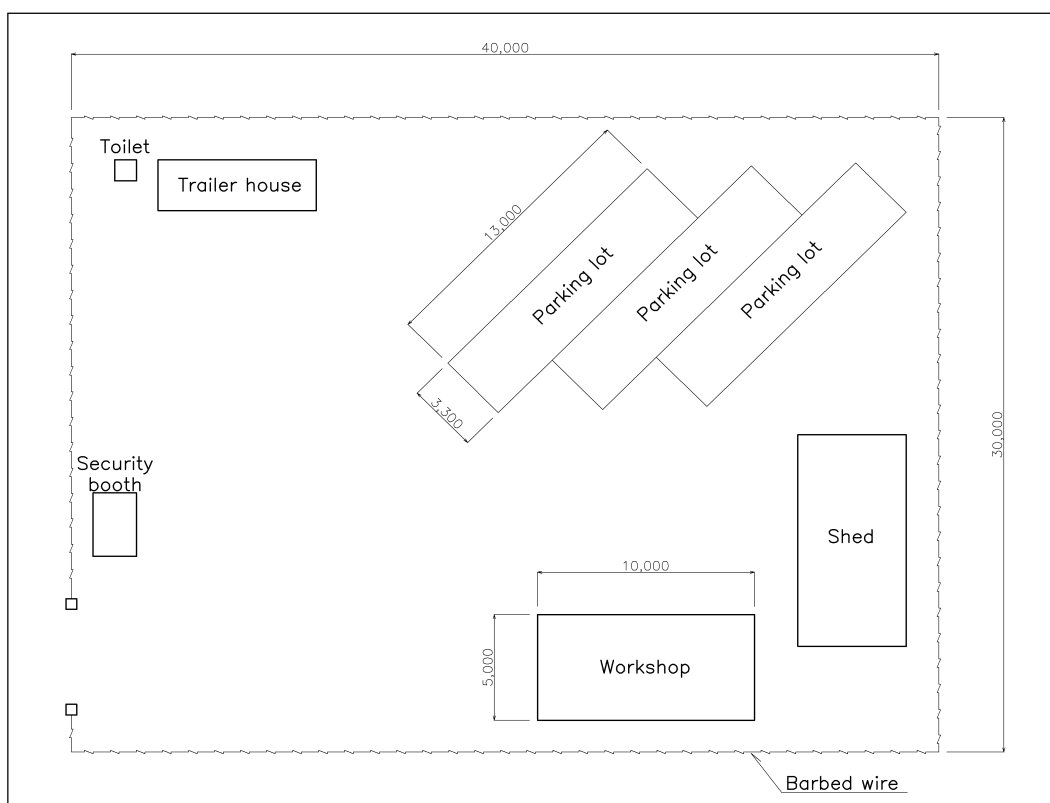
Planteo del Área de Construcción Tipo Estándar
